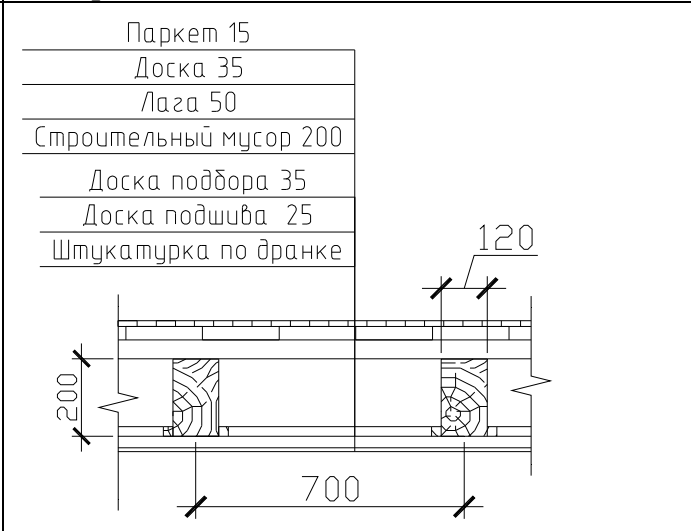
Перекрытие над третьим этажом в осях «3–8/А–Г»
